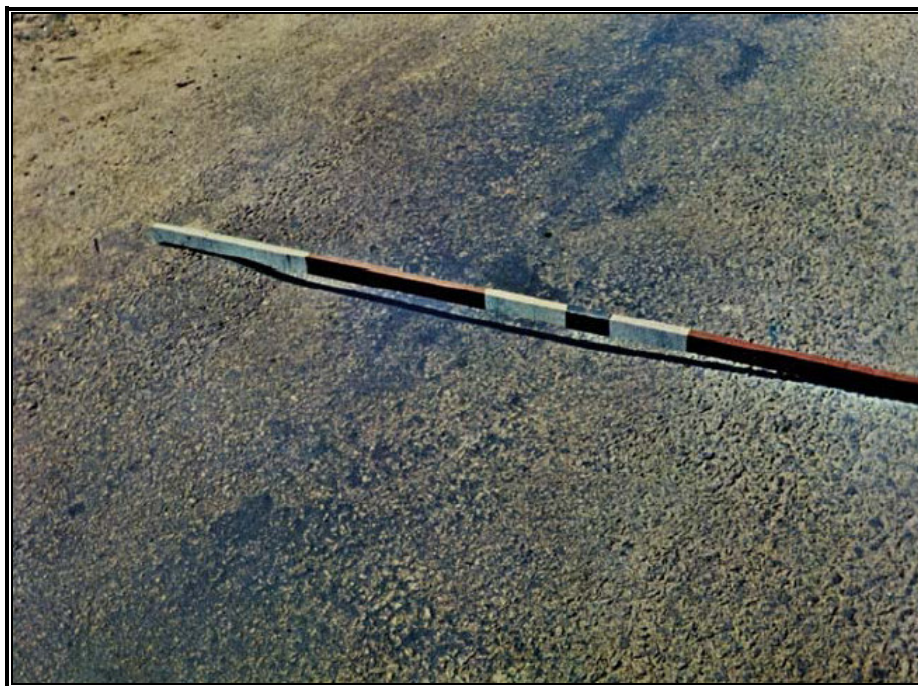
Afundamento de Pavimento, DNIT (2003)
